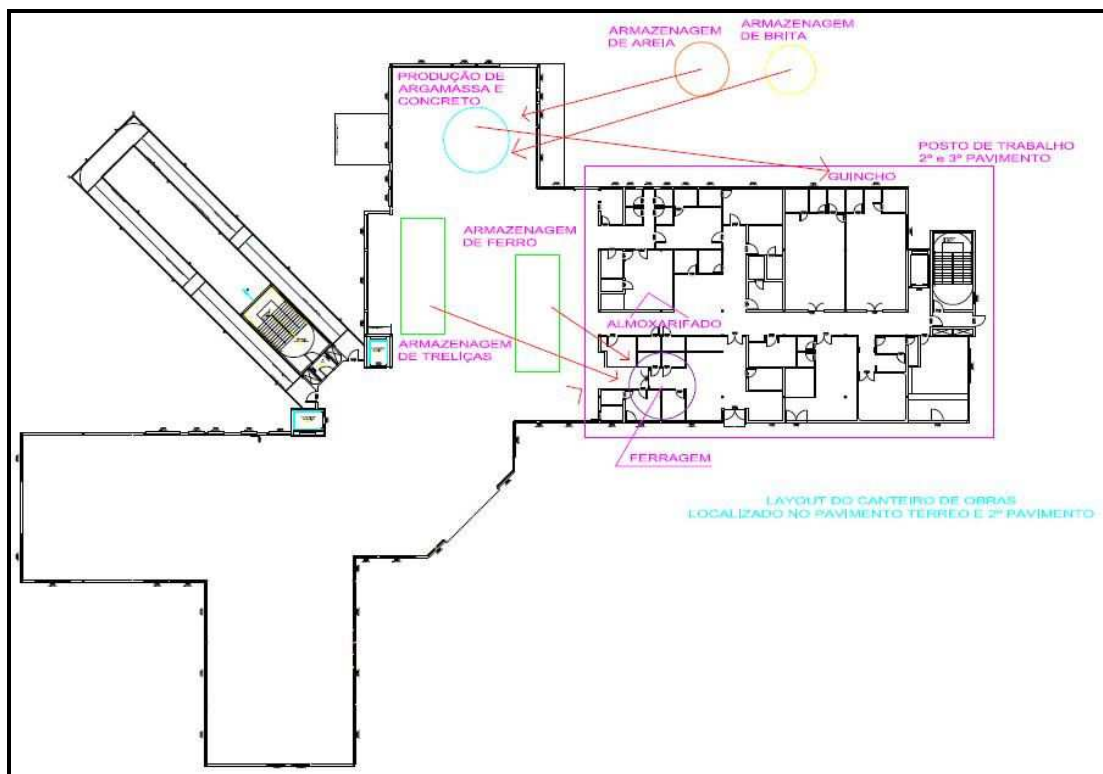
Layout do canteiro de obras após alterações para melhorar o fluxo.
